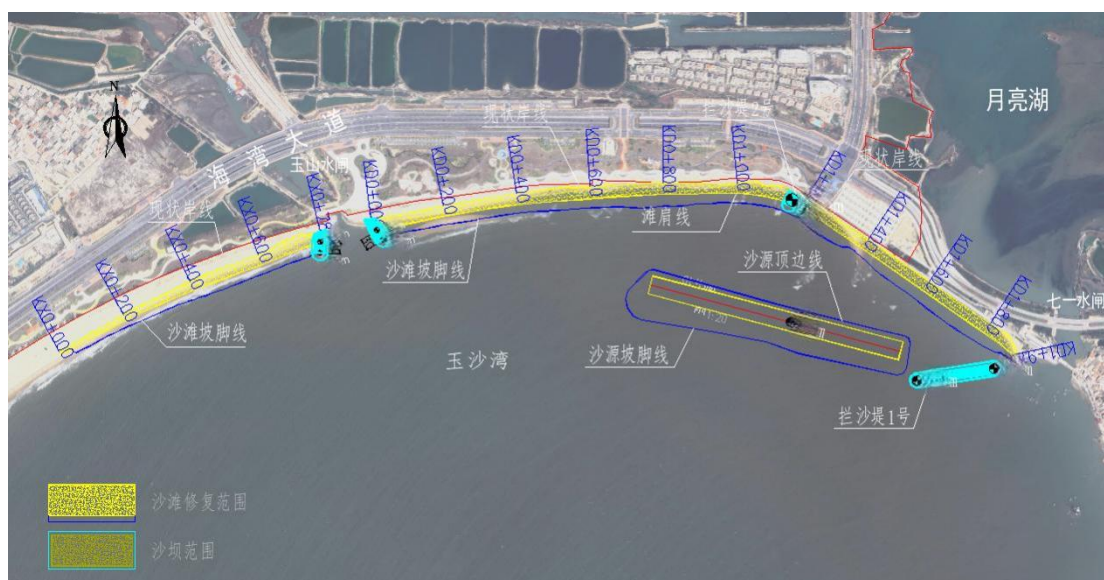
玉沙湾砂质岸线修复平面布置图（方案四）
